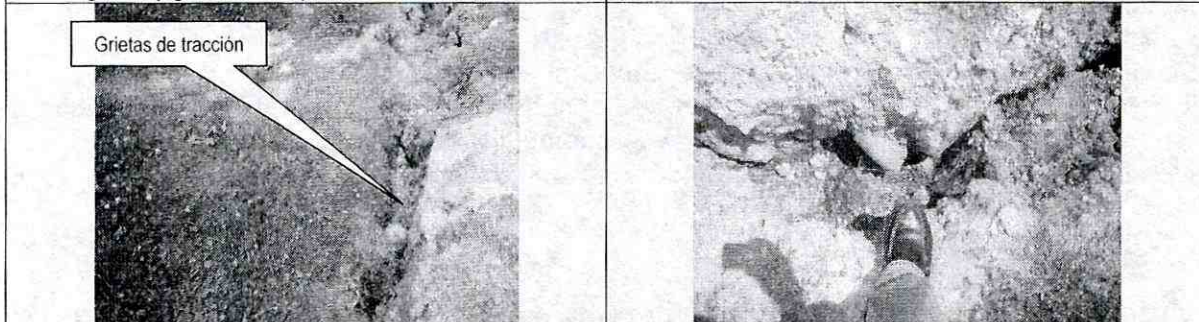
y 4. Se observan las grietas de tracción en la parte alta de la ladera en el costado oriental de la vivienda evaluada, las cuales tiene una longitud de 8 m y aberturas de 0.10 m aproximadamente.
